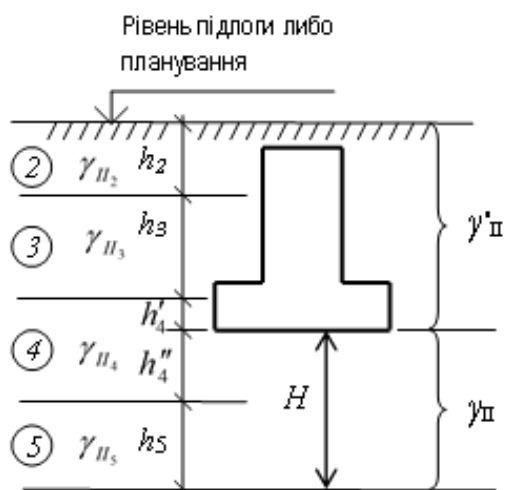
Схема до розрахунку питомої ваги ґрунту, розташованих вище і нижче підшоши фундаменту
